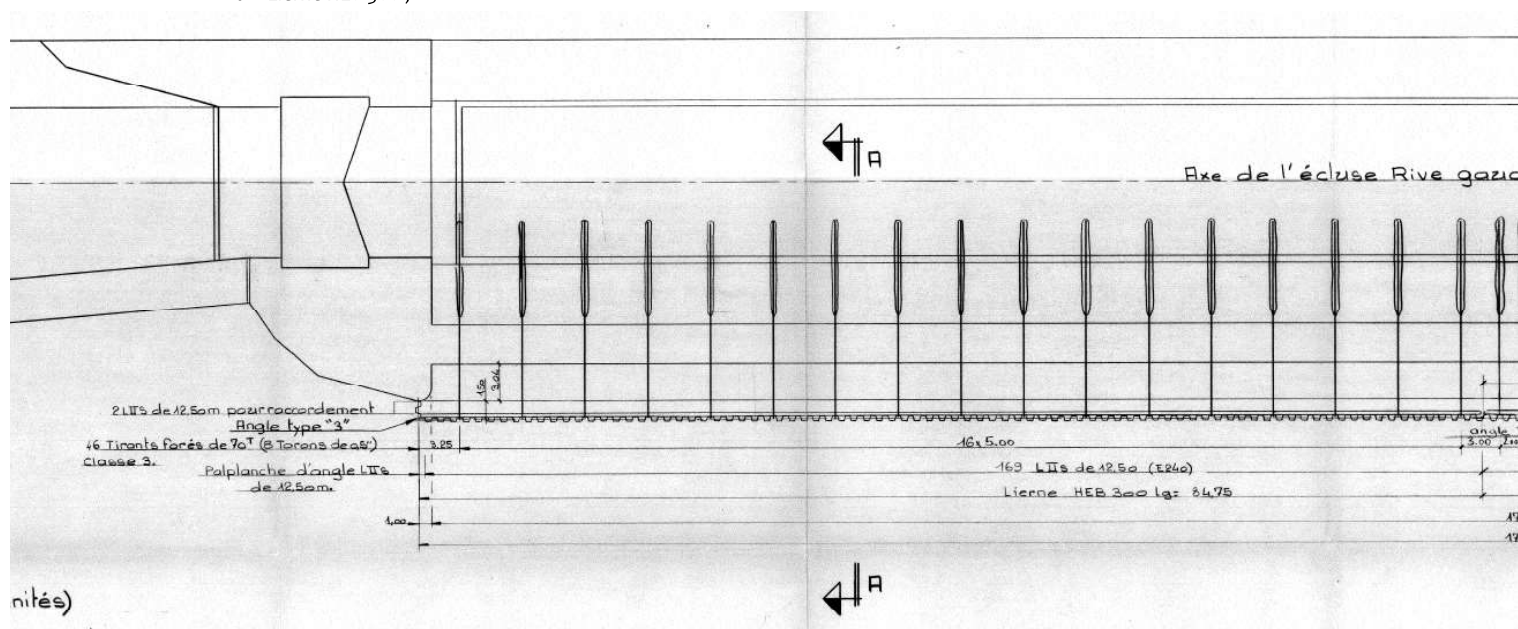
Plan rideau tirant zone amont (Archives VNF)
